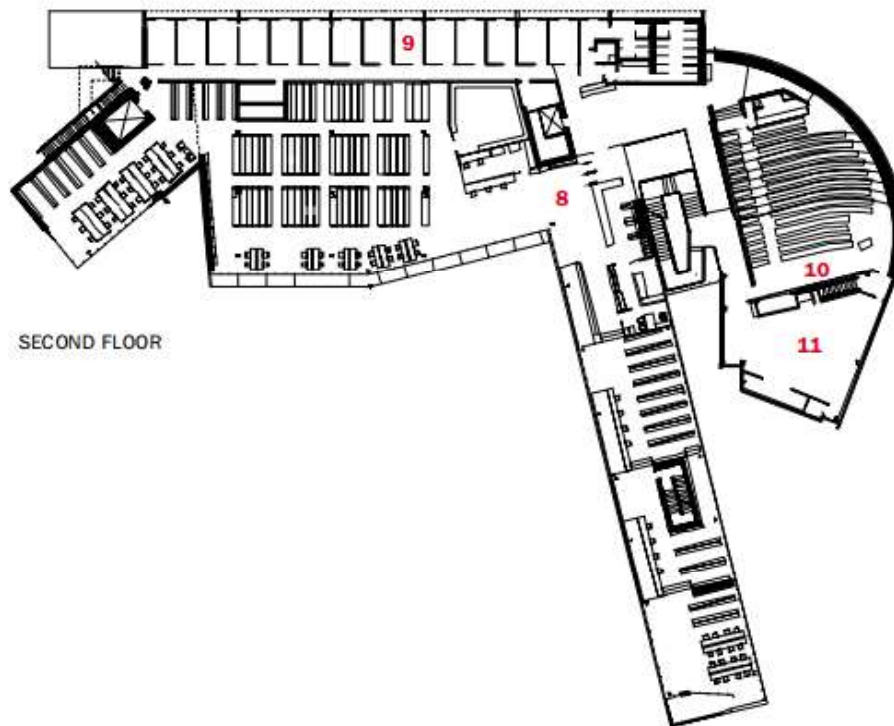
Planta Baixa do Primeiro Pavimento. (Fonte: Architectural Record, 2007).
